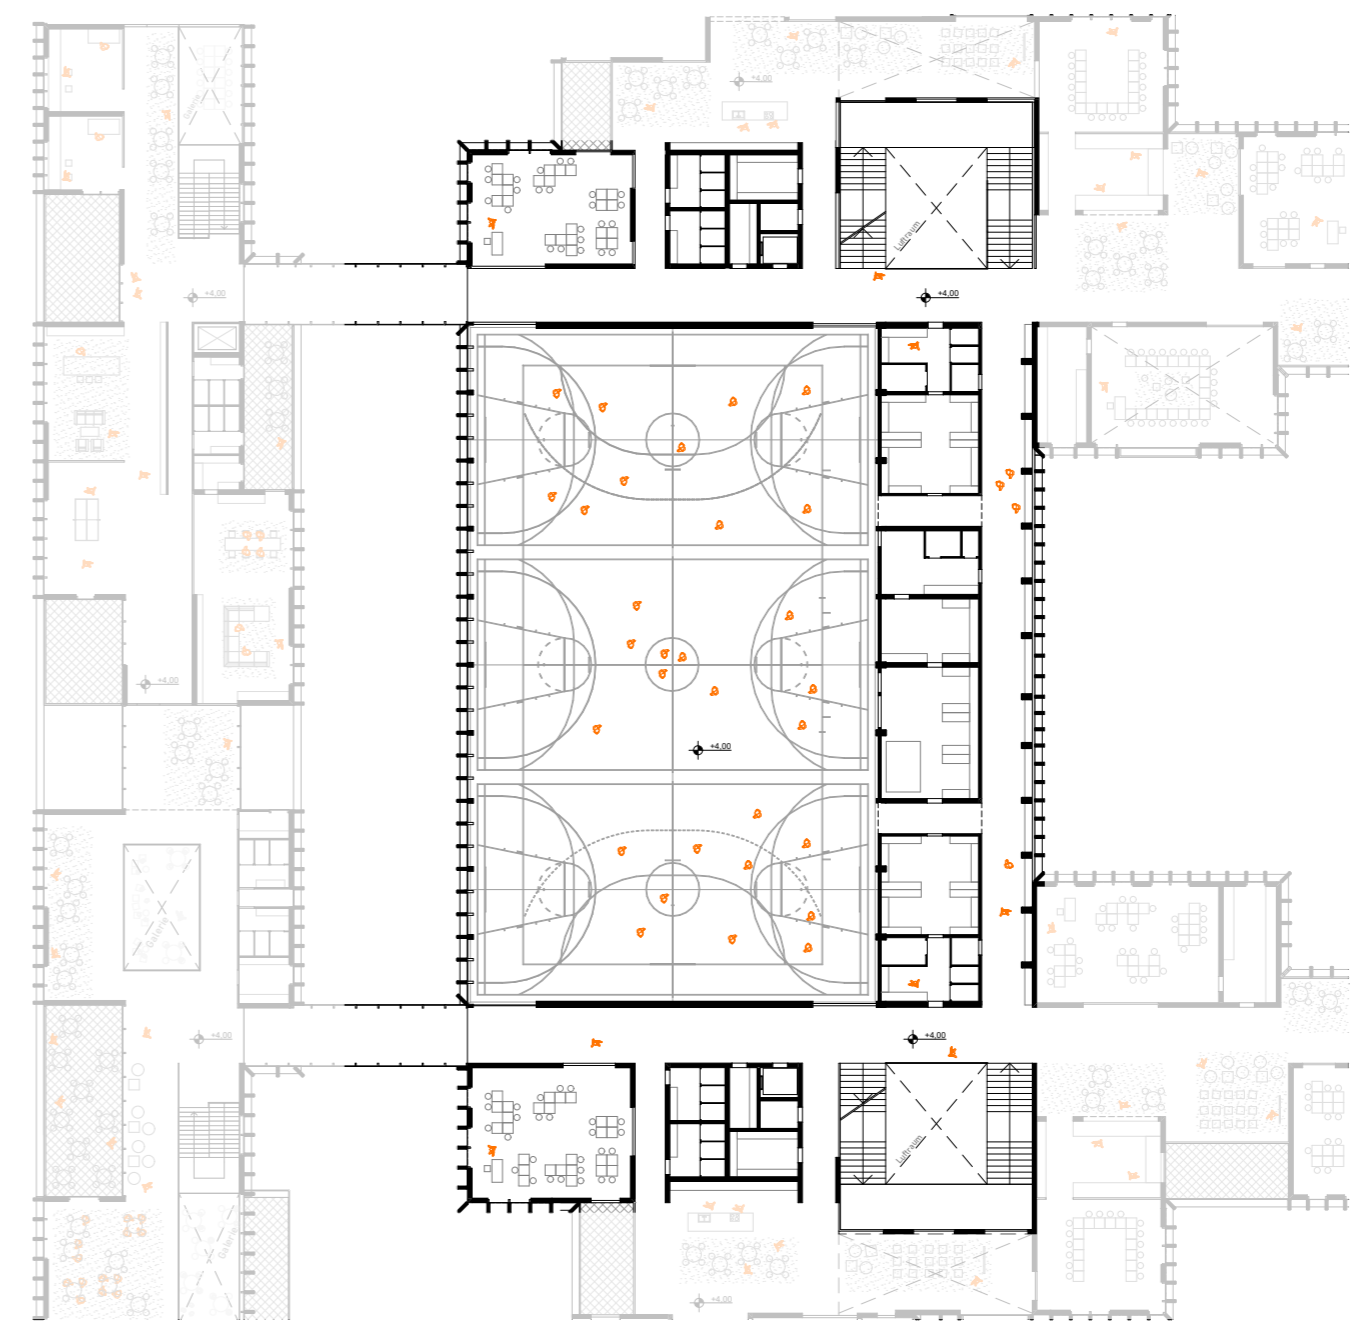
Grundriss Abschnitt-Sportbereich
